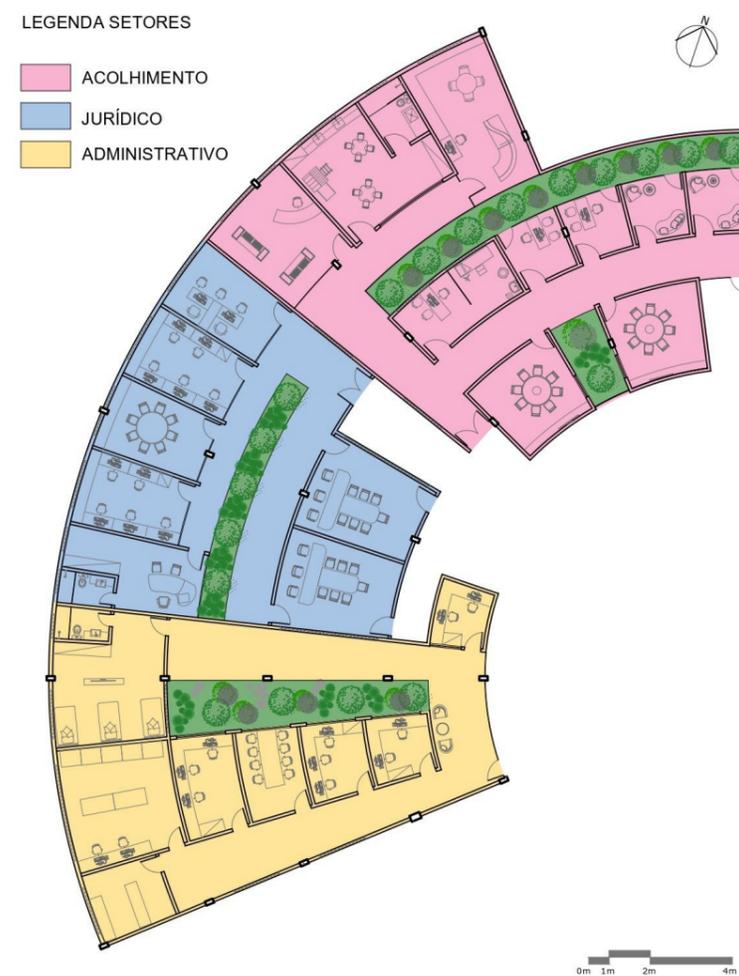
Planta Baixa dos Setores Acolhimento, Jurídico e Administrativo
